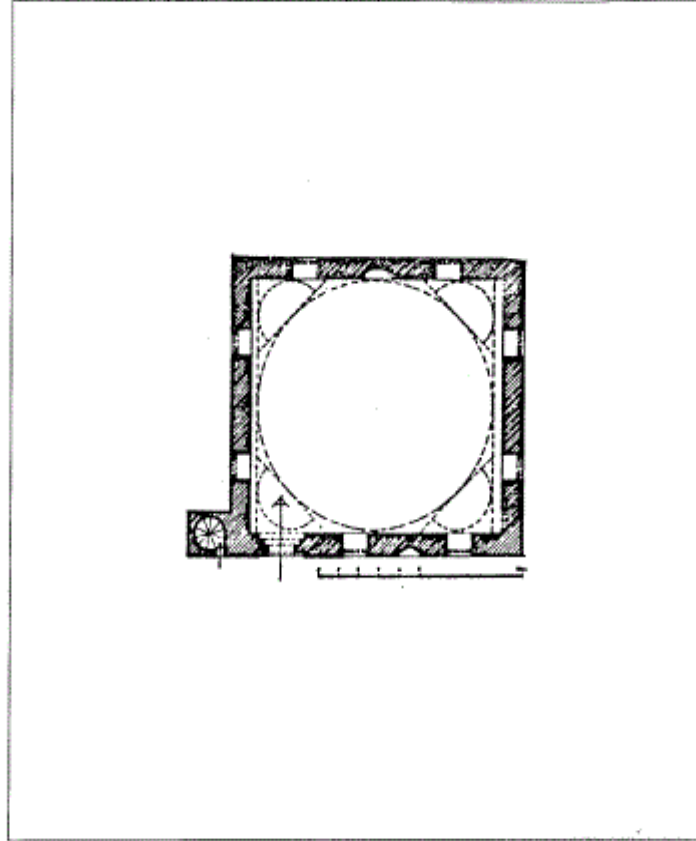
مسقط أفقي لمسجد شاه ملك في أدرة (عن: أصلان أبا) .
